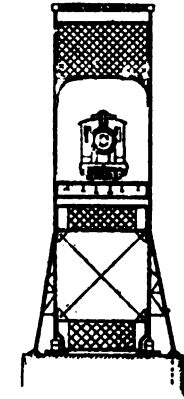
Pont de Lachine. Coupe sur la pile comprise entre les deux travées marinières.
